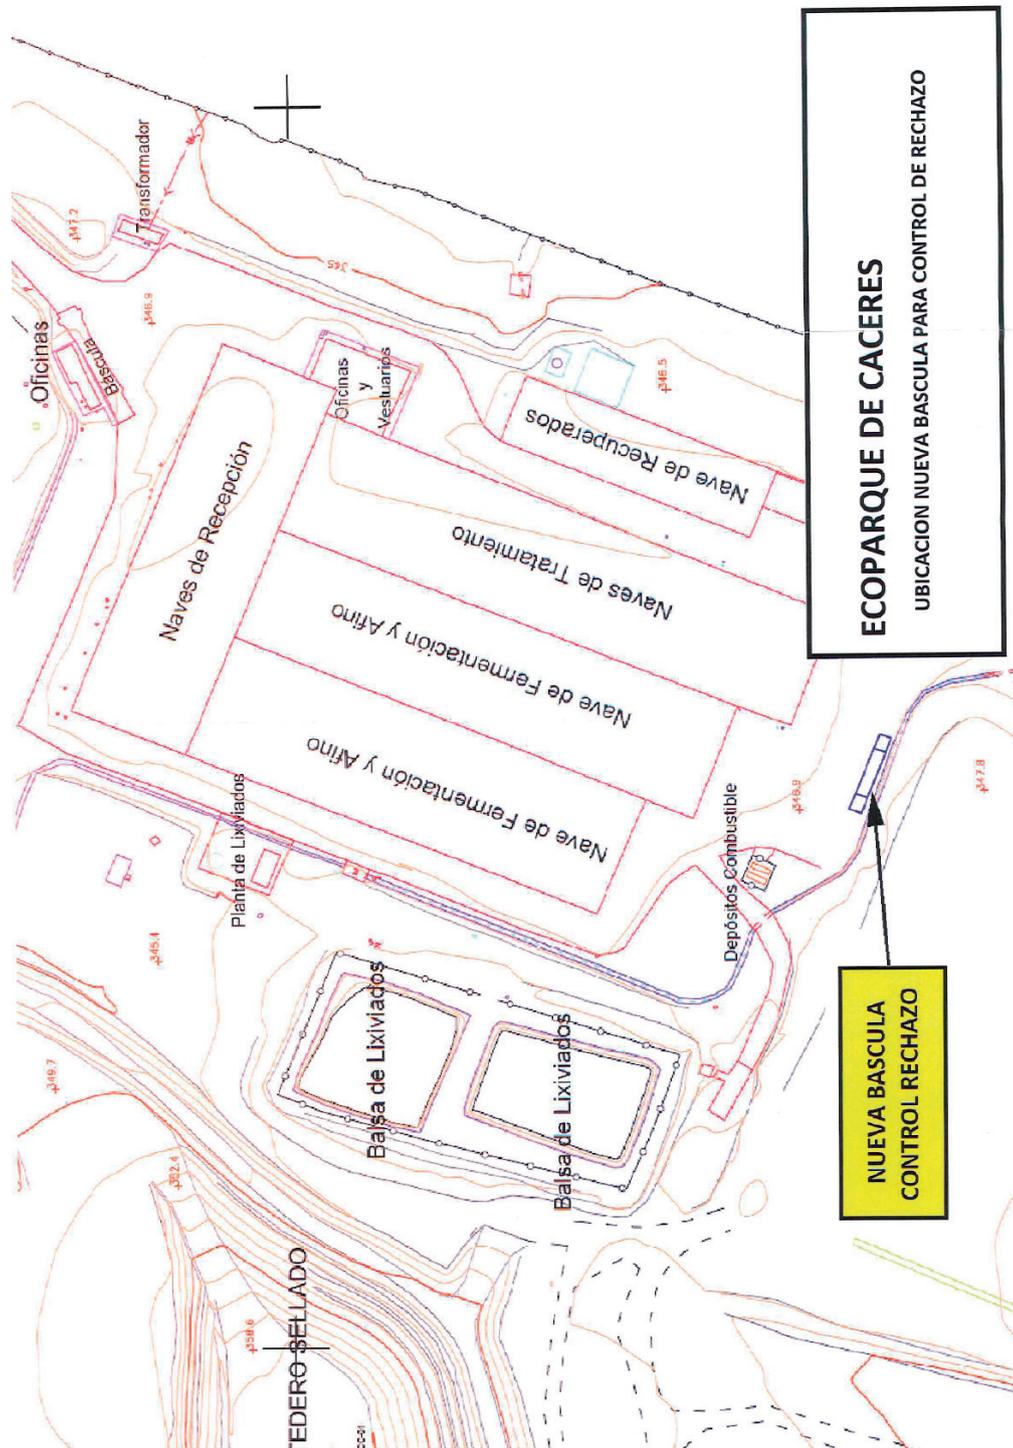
Plano 1 en planta de la instalación. Zona de tratamiento.
